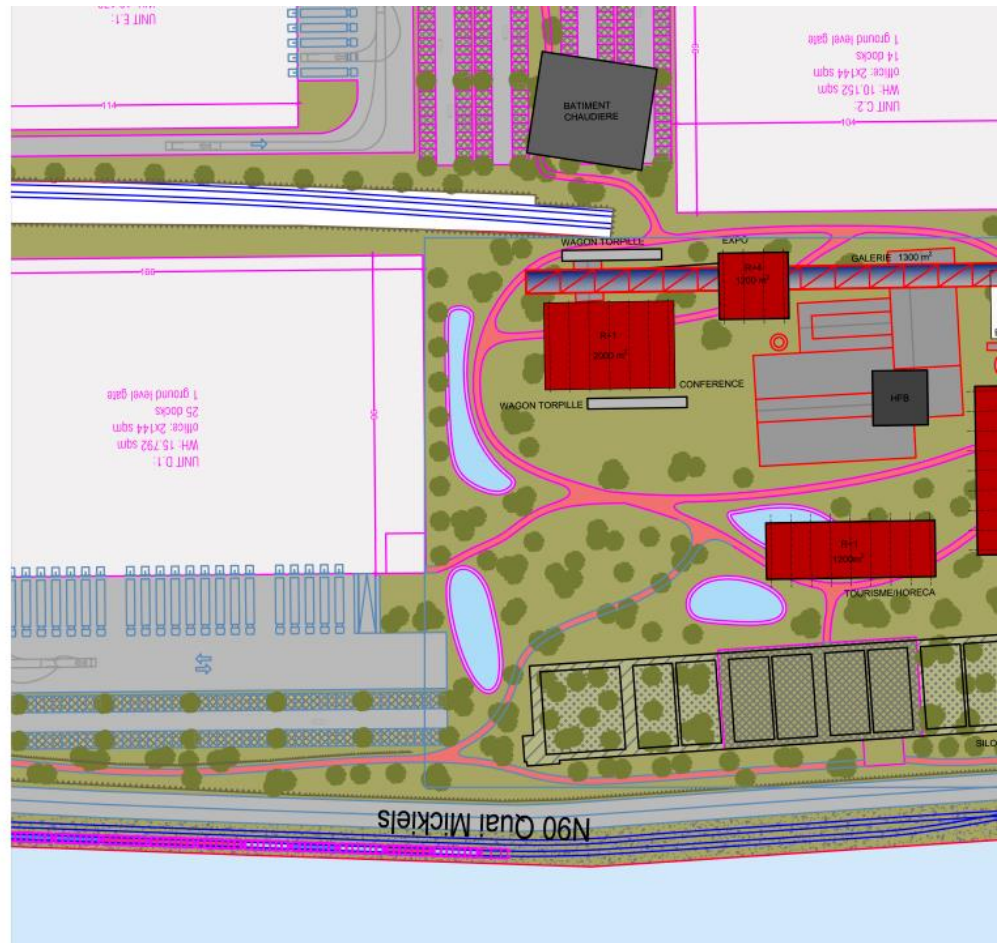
Plan du projet avec zoom sur le parc (©Valentiny Architectes, s.d.).
